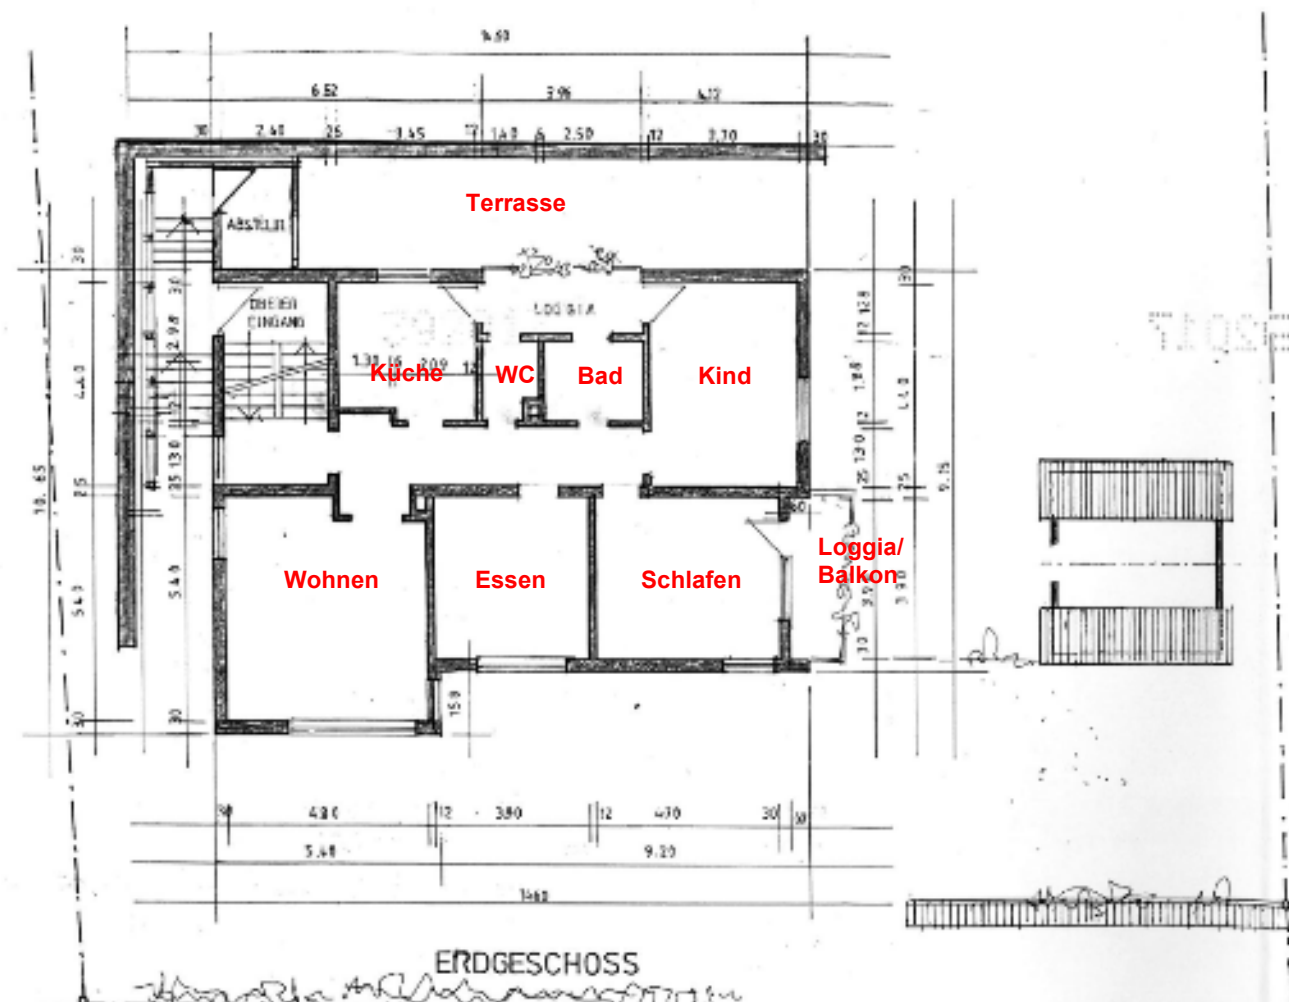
Grundriss Erdgeschoss; Quelle: Bauakte; Dachgeschossausbau Nachgesuch; 2017; Roteintragungen durch den SV
